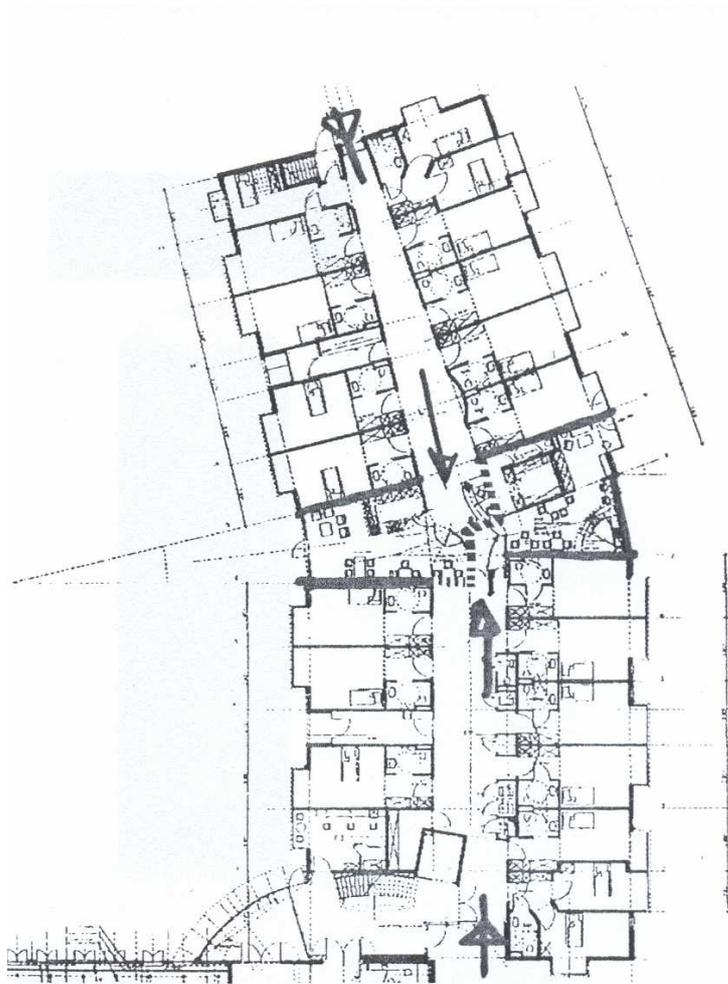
Grundrisszeichnung Rablinghausen
